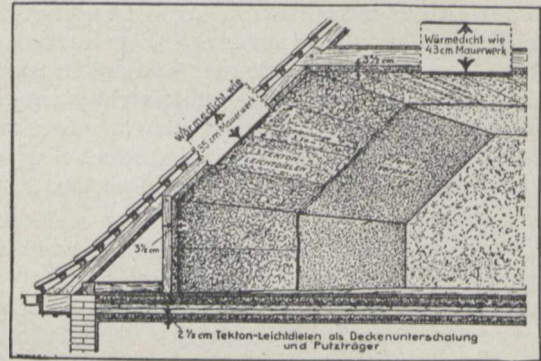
Ausbau von Dachgeschossen mit Tekton-Dielen.
